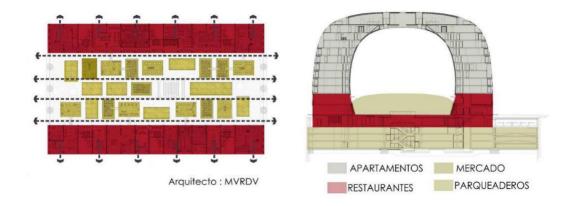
Planos Plaza Markthal Rotterdam-Holanda
